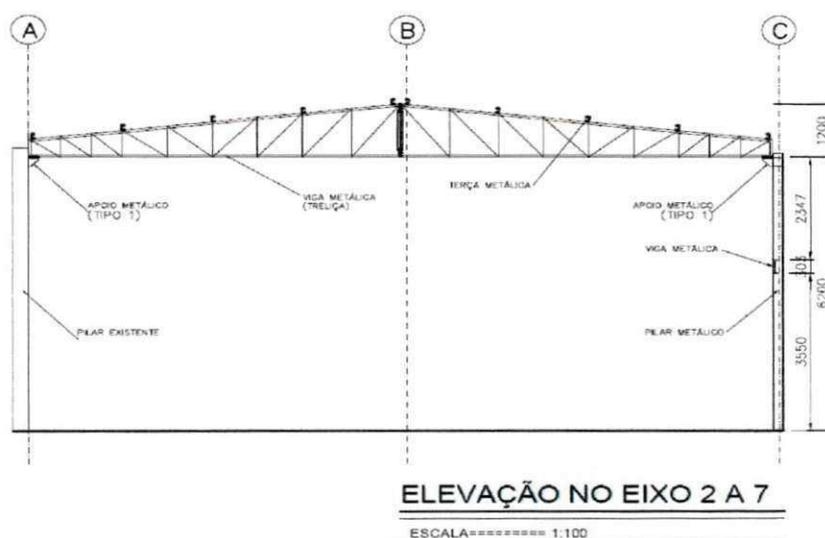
Croqui do projeto do São Braz –Cabedelo-Pb
